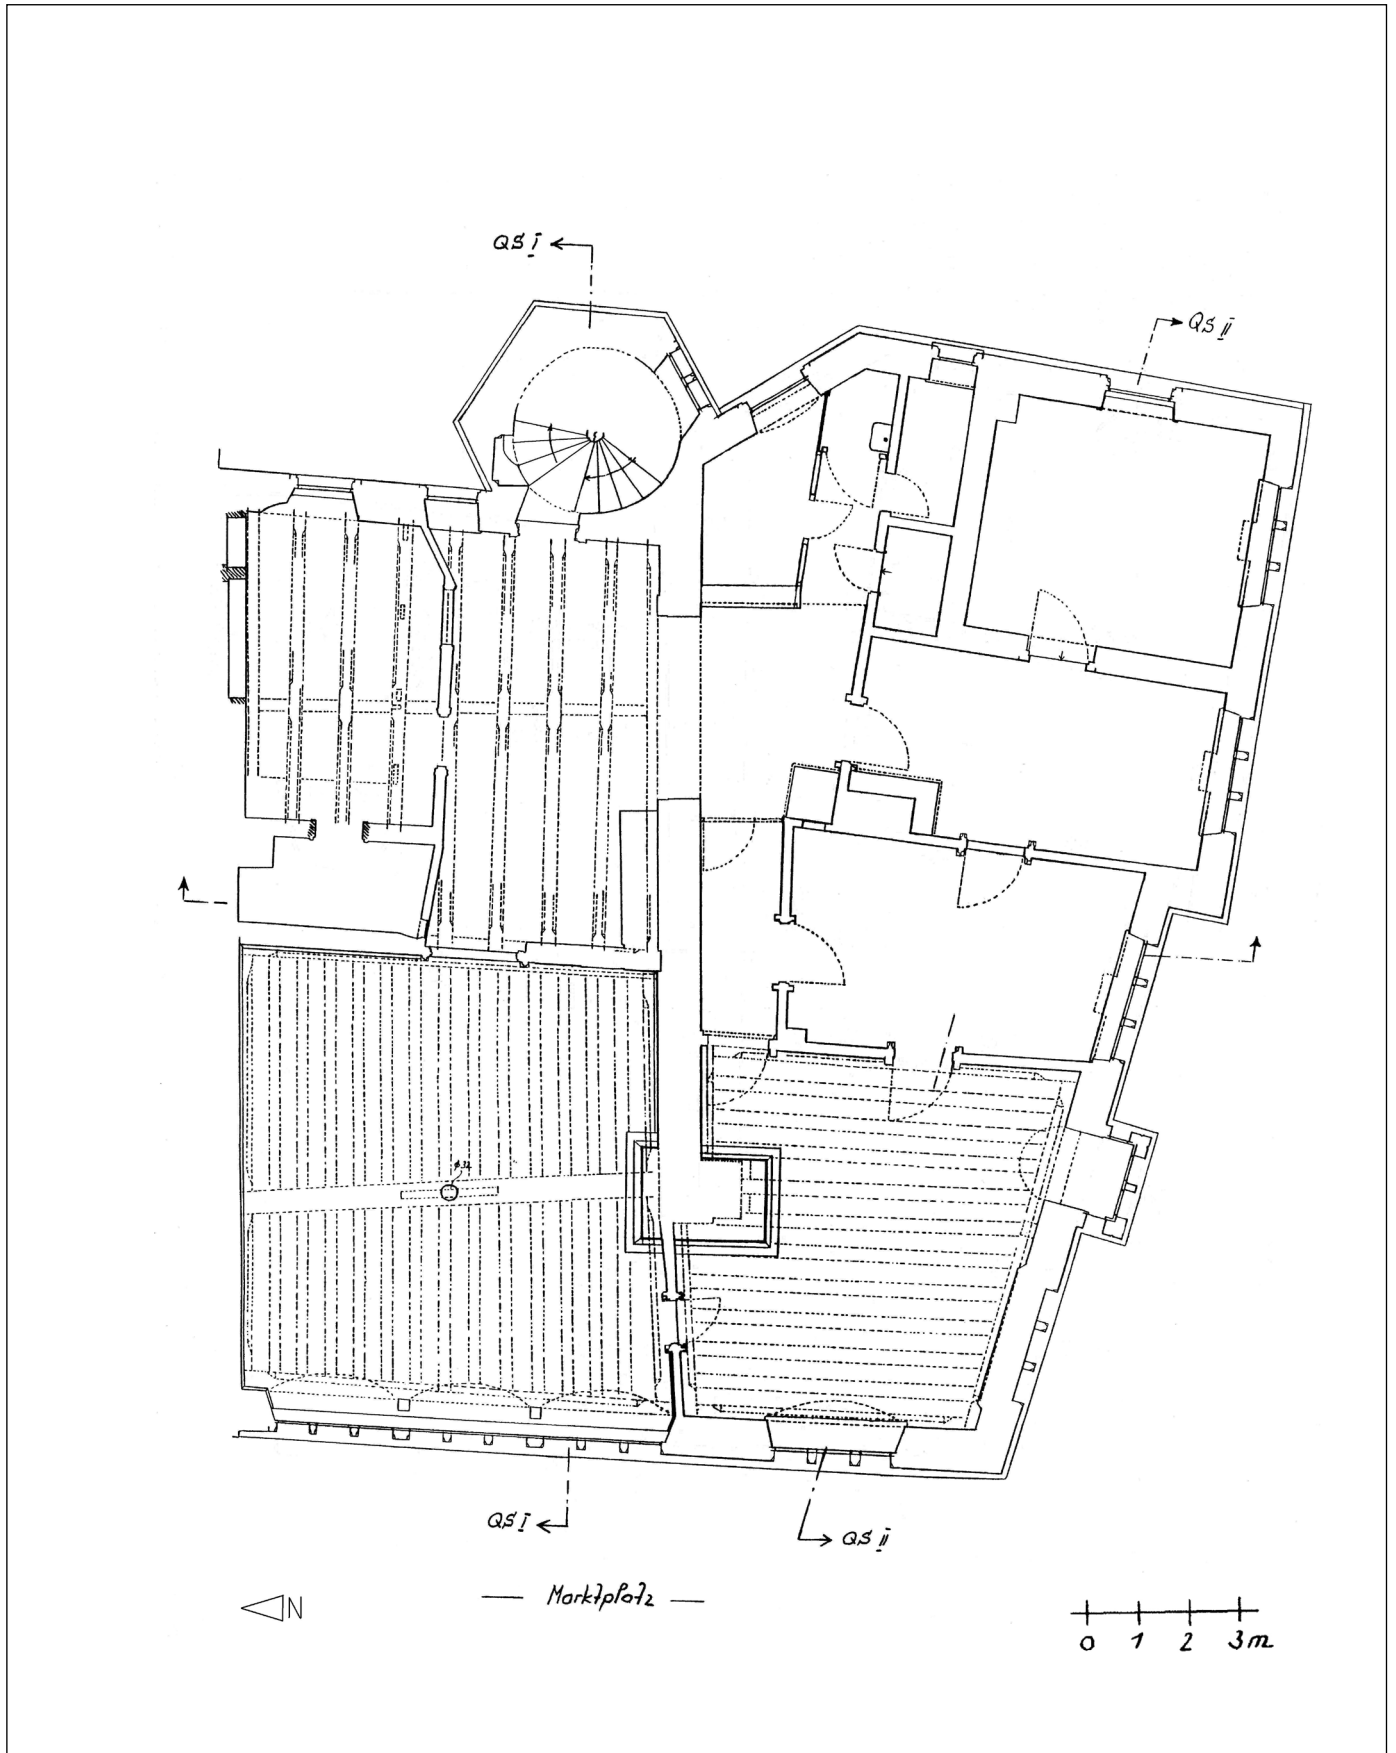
Hauptstraße 53, Rathaus, Grundriss 1. Obergeschoss, M. 1:150.
